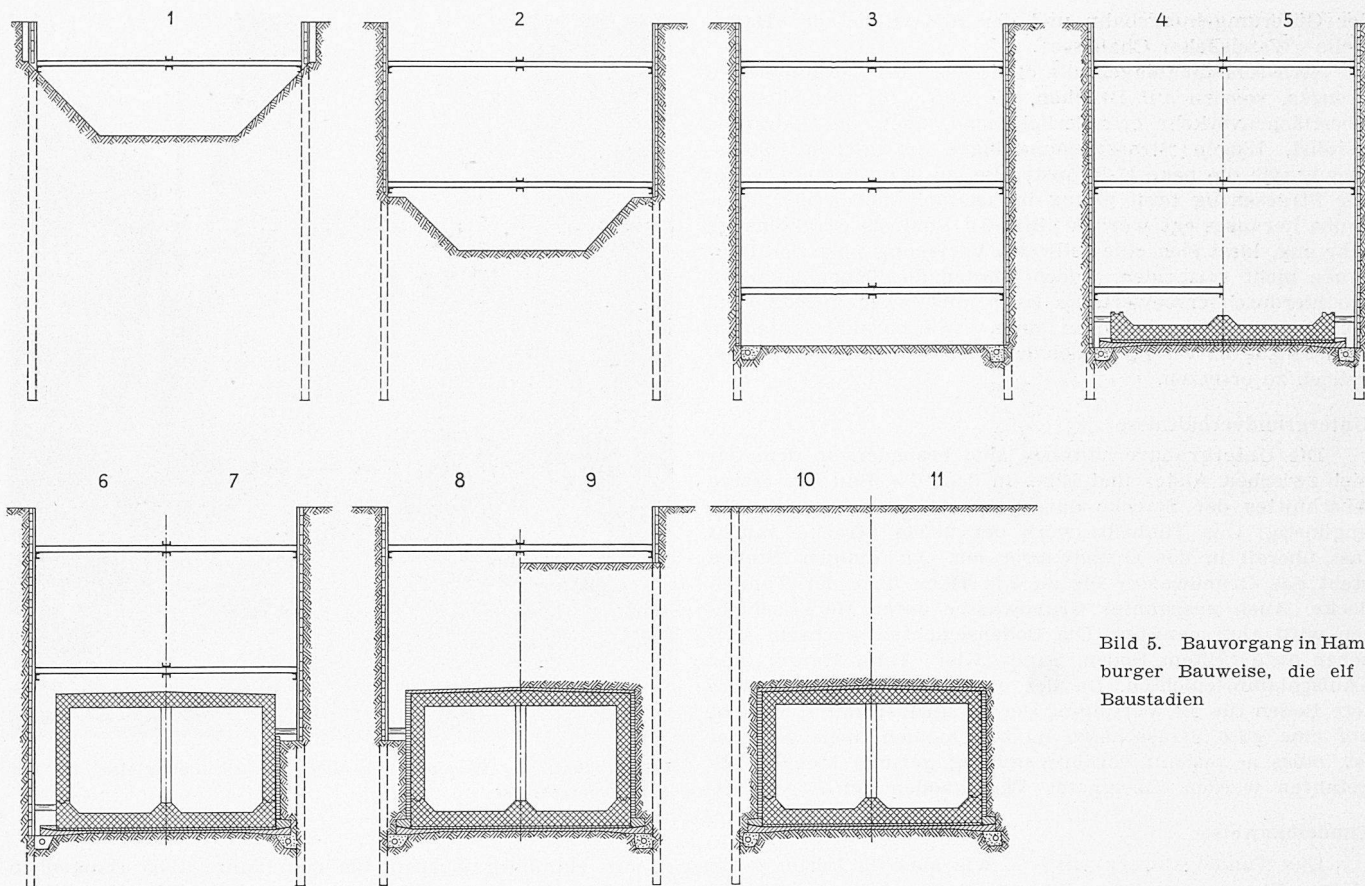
Bauvorgang in Hamburger Bauweise, die elf Baustadien
